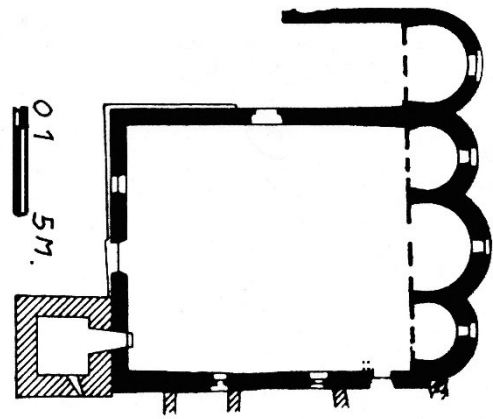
Grundriss von St. Johann in Müstair
